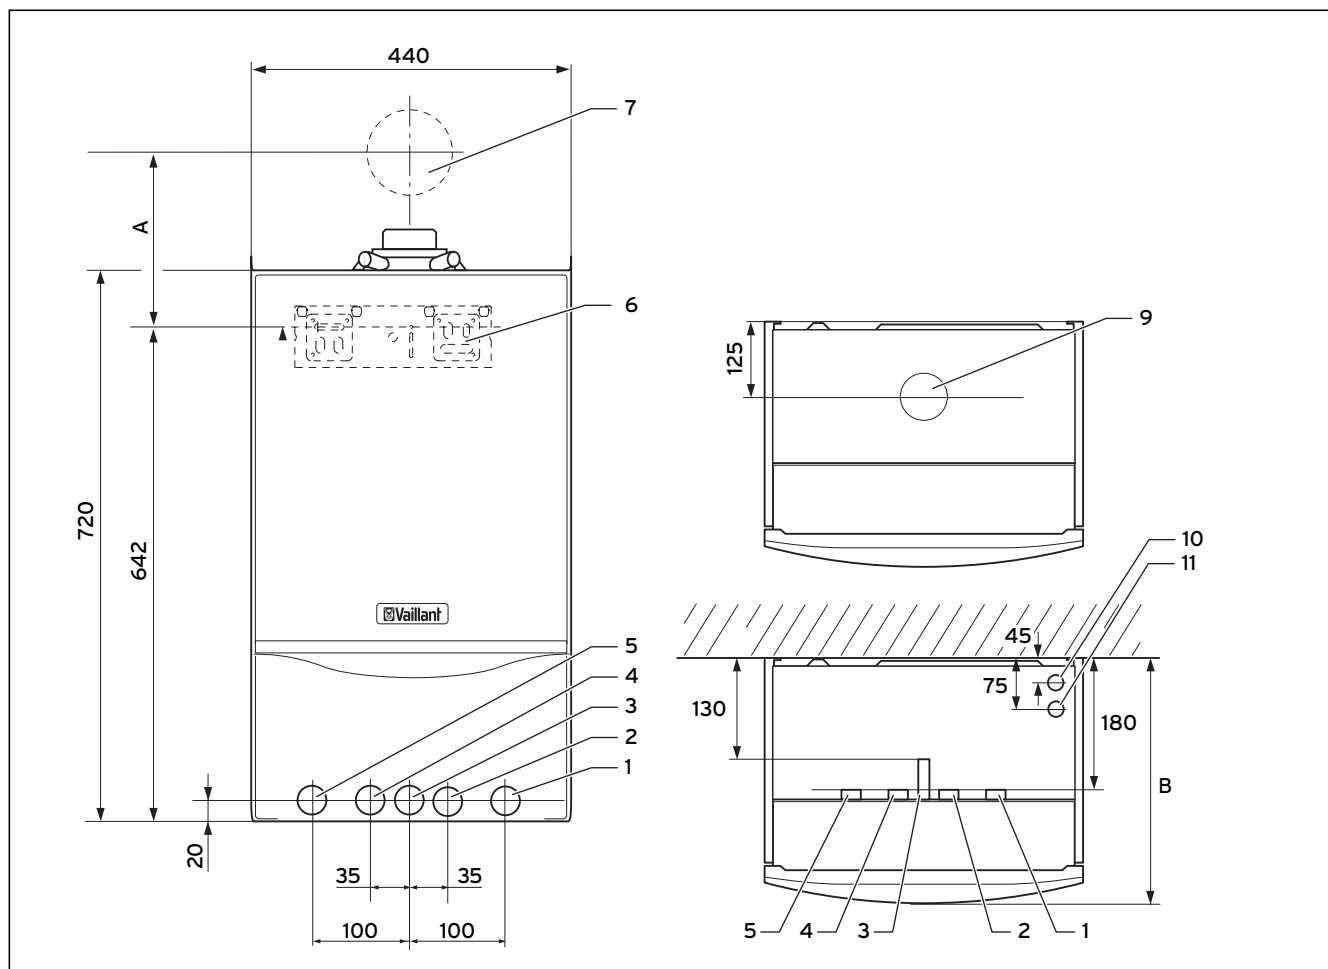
Dimensiunea de racordare în mm (aparate VUW)
